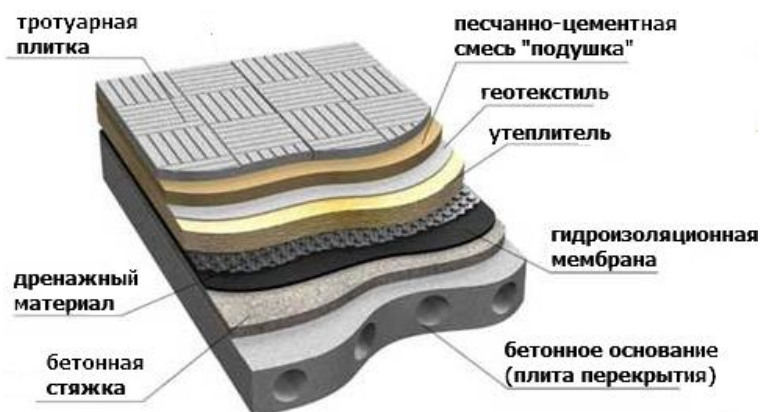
Схема расположения слоев при инверсионном покрытии кровли
